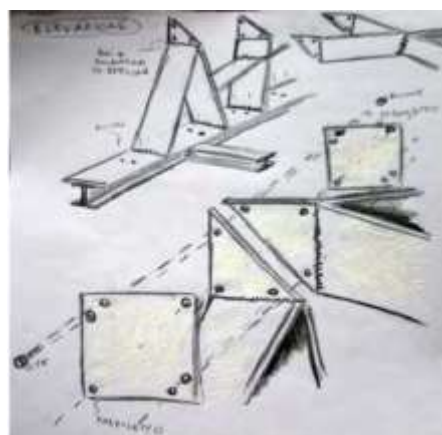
Représentation du système structurel d'élévation et de la jonction entre les éléments verticaux et ceux de la toiture - Brontolo Group
